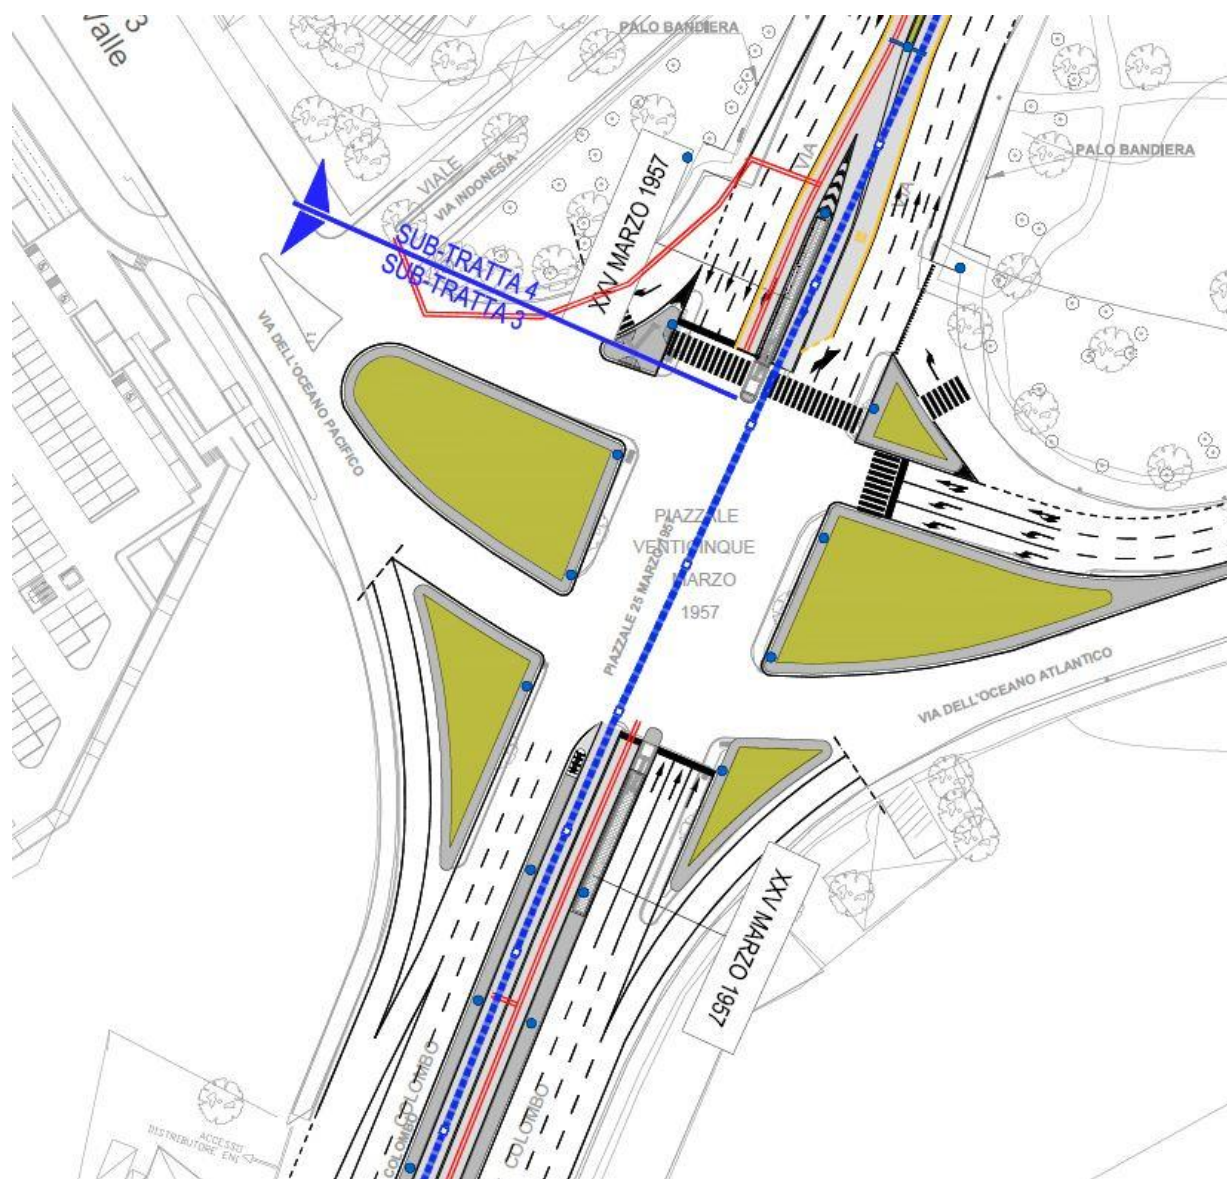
stralcio planimetrico sistemazione piazzale XV Marzo 1957 presentato in CdS
